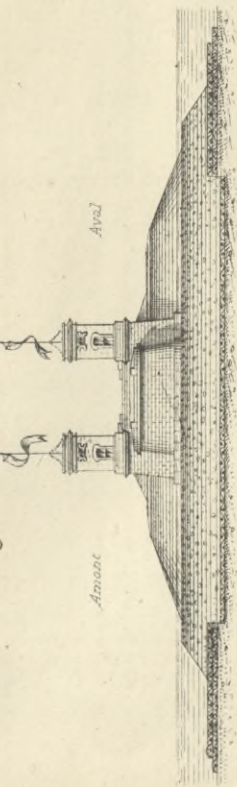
Vue de face, à 0^m.001 p^r 1^m.00.
